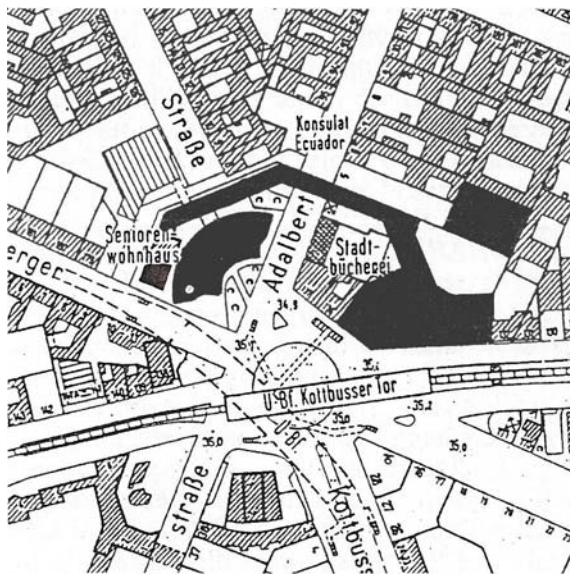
e 9 : Kreuzberg, progetto del nuovo Kreuzberg Zentrum dell'architetto J. Krawina (1) e planimetria.
